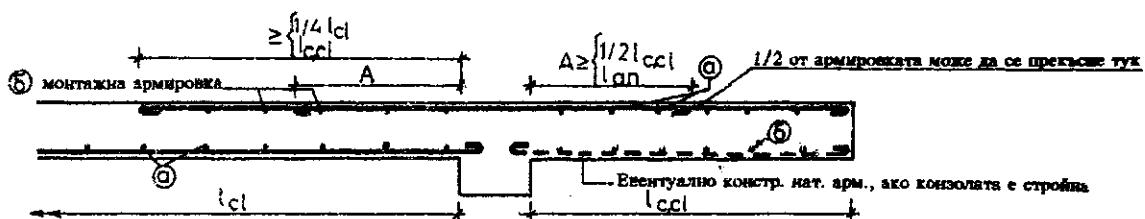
Места на огъване или прекъсване на армировката при непрекъснати площи с еднакви отвори
